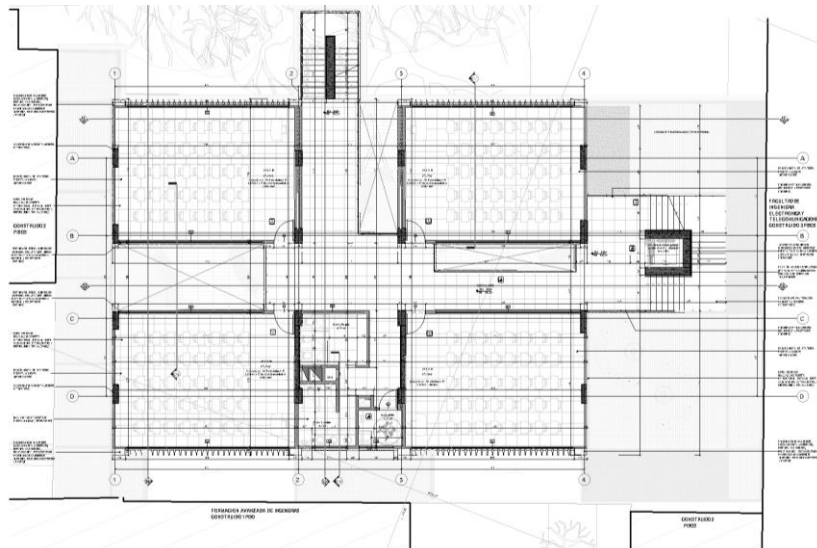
Plano en planta segundo piso<sup>22</sup>
